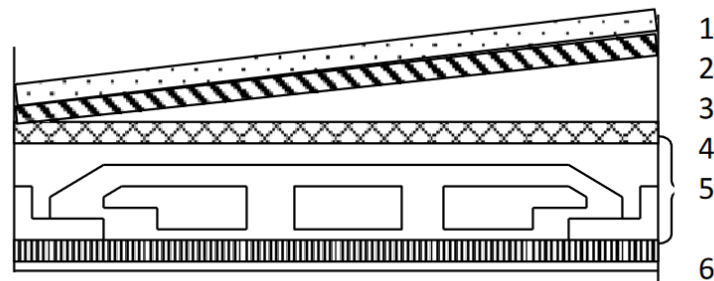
Éléments constituant le plancher terrasse inaccessible
